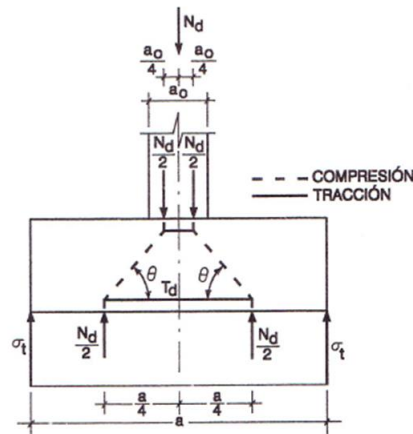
Modelo de bielas y tirantes para zapata rígida bajo carga concentrada (fuente: Jiménez Montoya, 2009)
